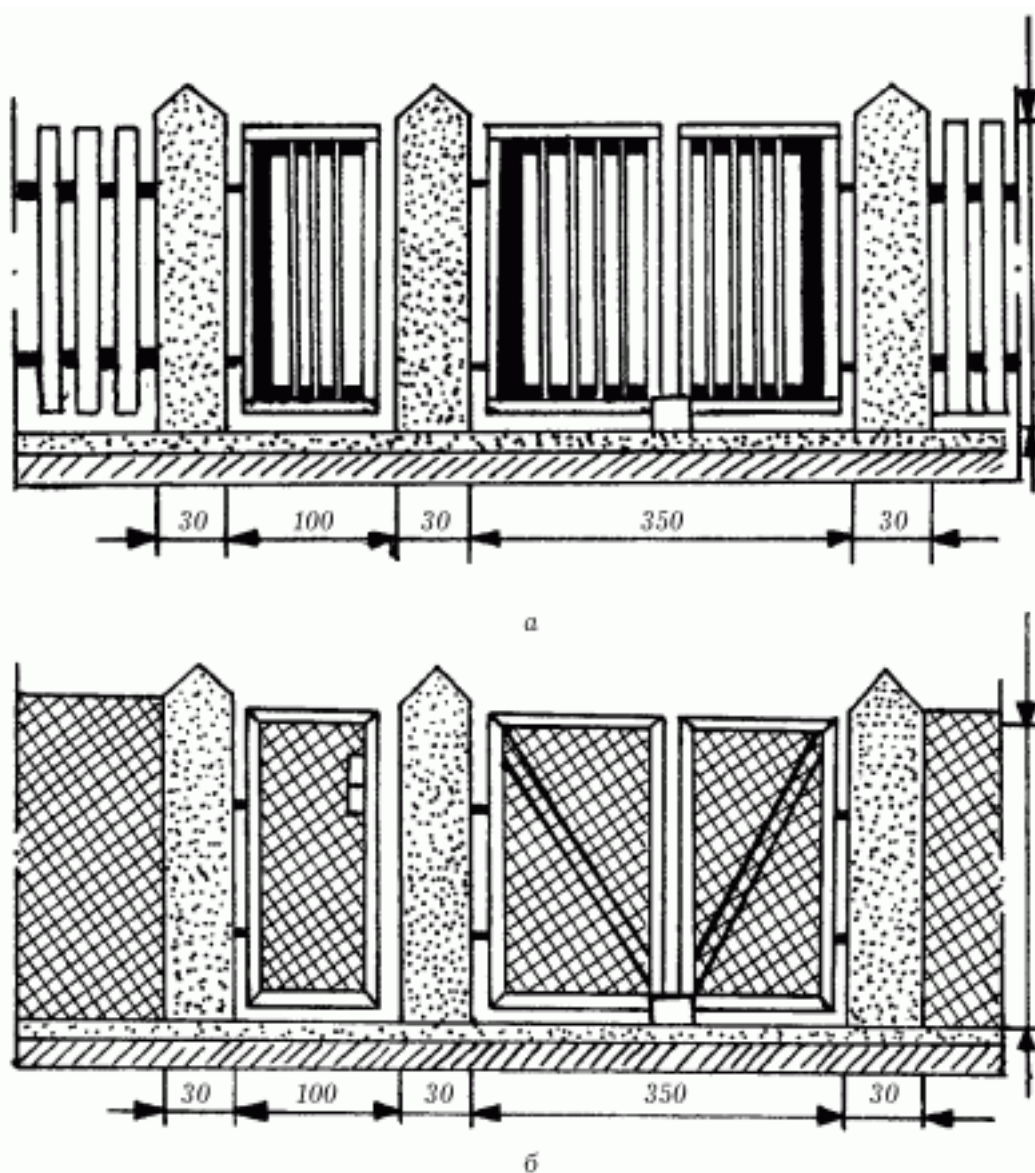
Ворота на железобетонных столбах: а – с деревянной решеткой; б – с металлической сеткой.
